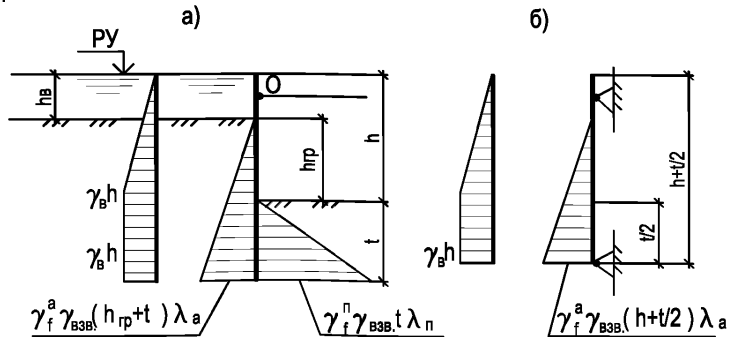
Схема, используемая в расчетах шпунтовых ограждений, не имеющих распорных креплений в водонепроницаемых грунтах с применением водозащитной подушки
